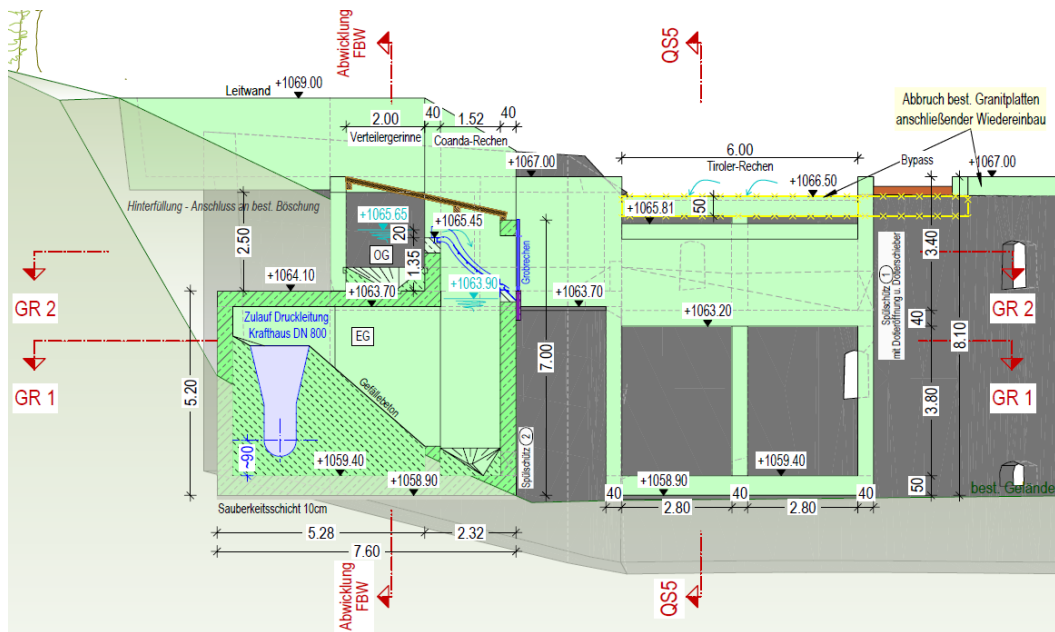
Querschnitt geplantes Fassungsbauwerk – Coanda-Rechen und Einlauf zur Hauptturbine
